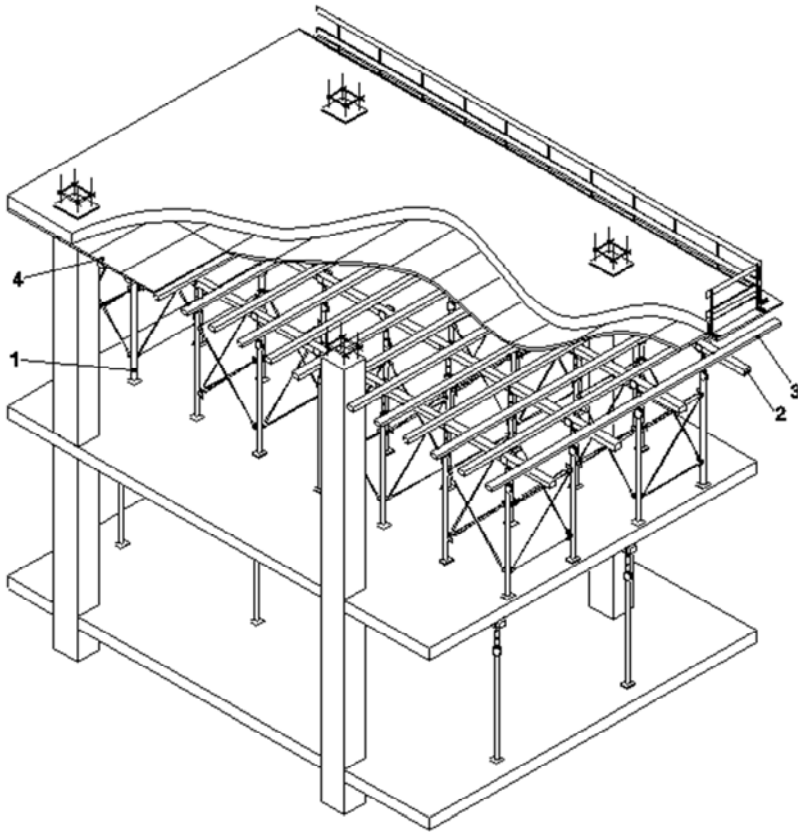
Опалубка перекрытия на основе опорных башен:
